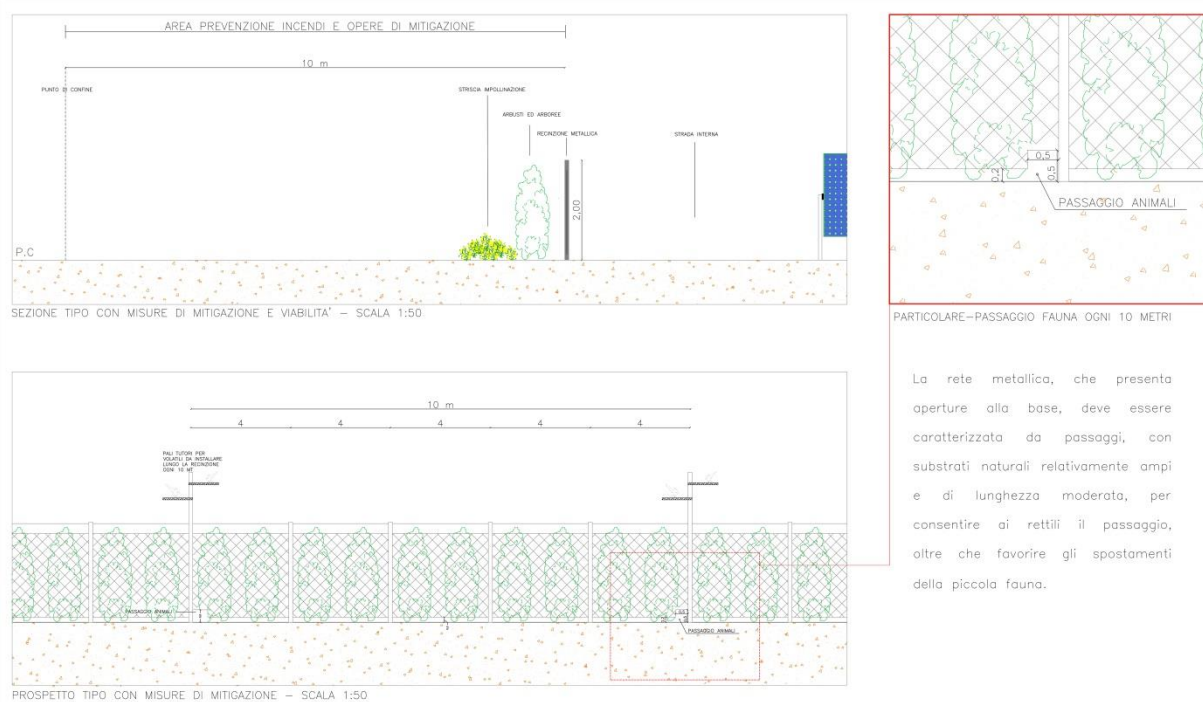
Sezione e schema tipo con opere di Mitigazione e Viabilità
